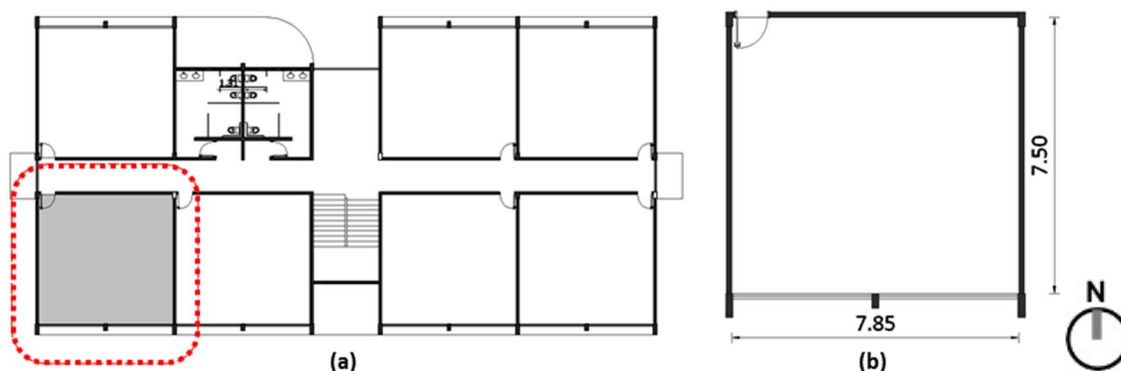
(a) Planta baixa pavimento superior e (b) planta baixa da sala de aula. Desenvolvido pelos Autores (2018).
